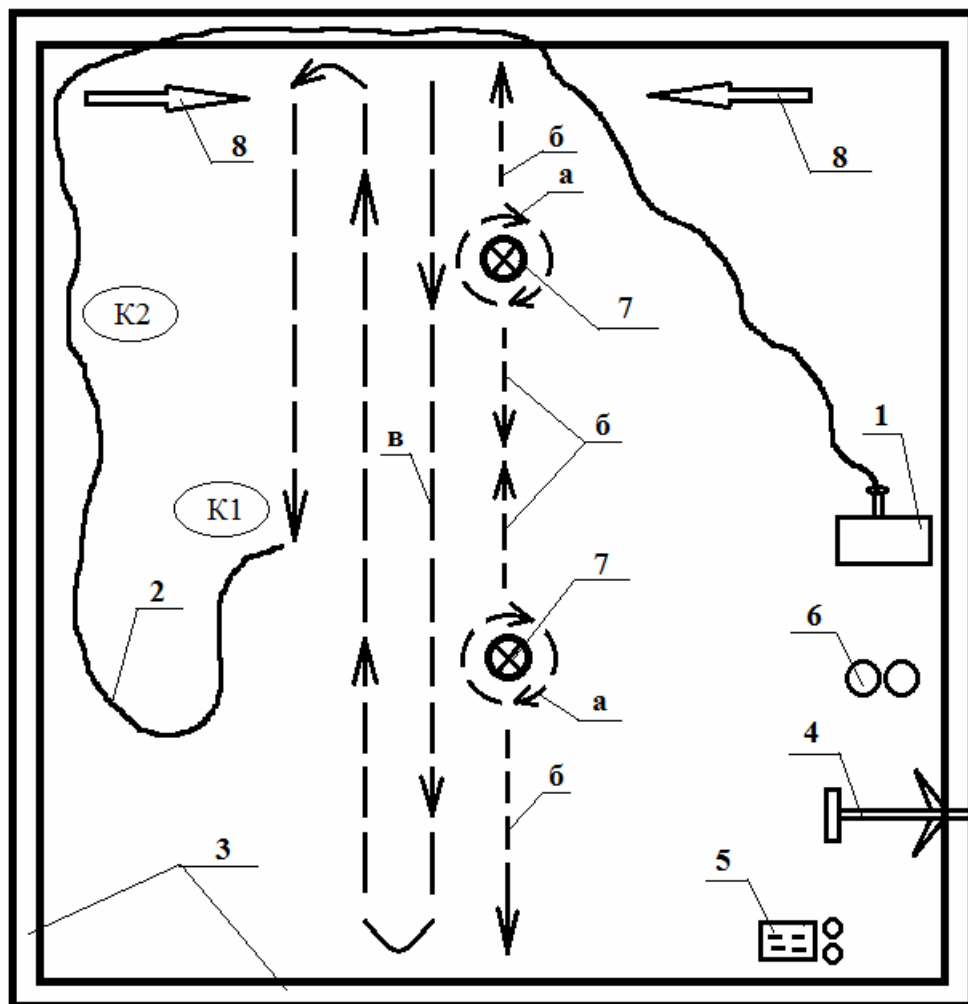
Схема организации рабочего места при устройстве кровли из мастики "Профикс", размещение насосной станции - на кровле:
